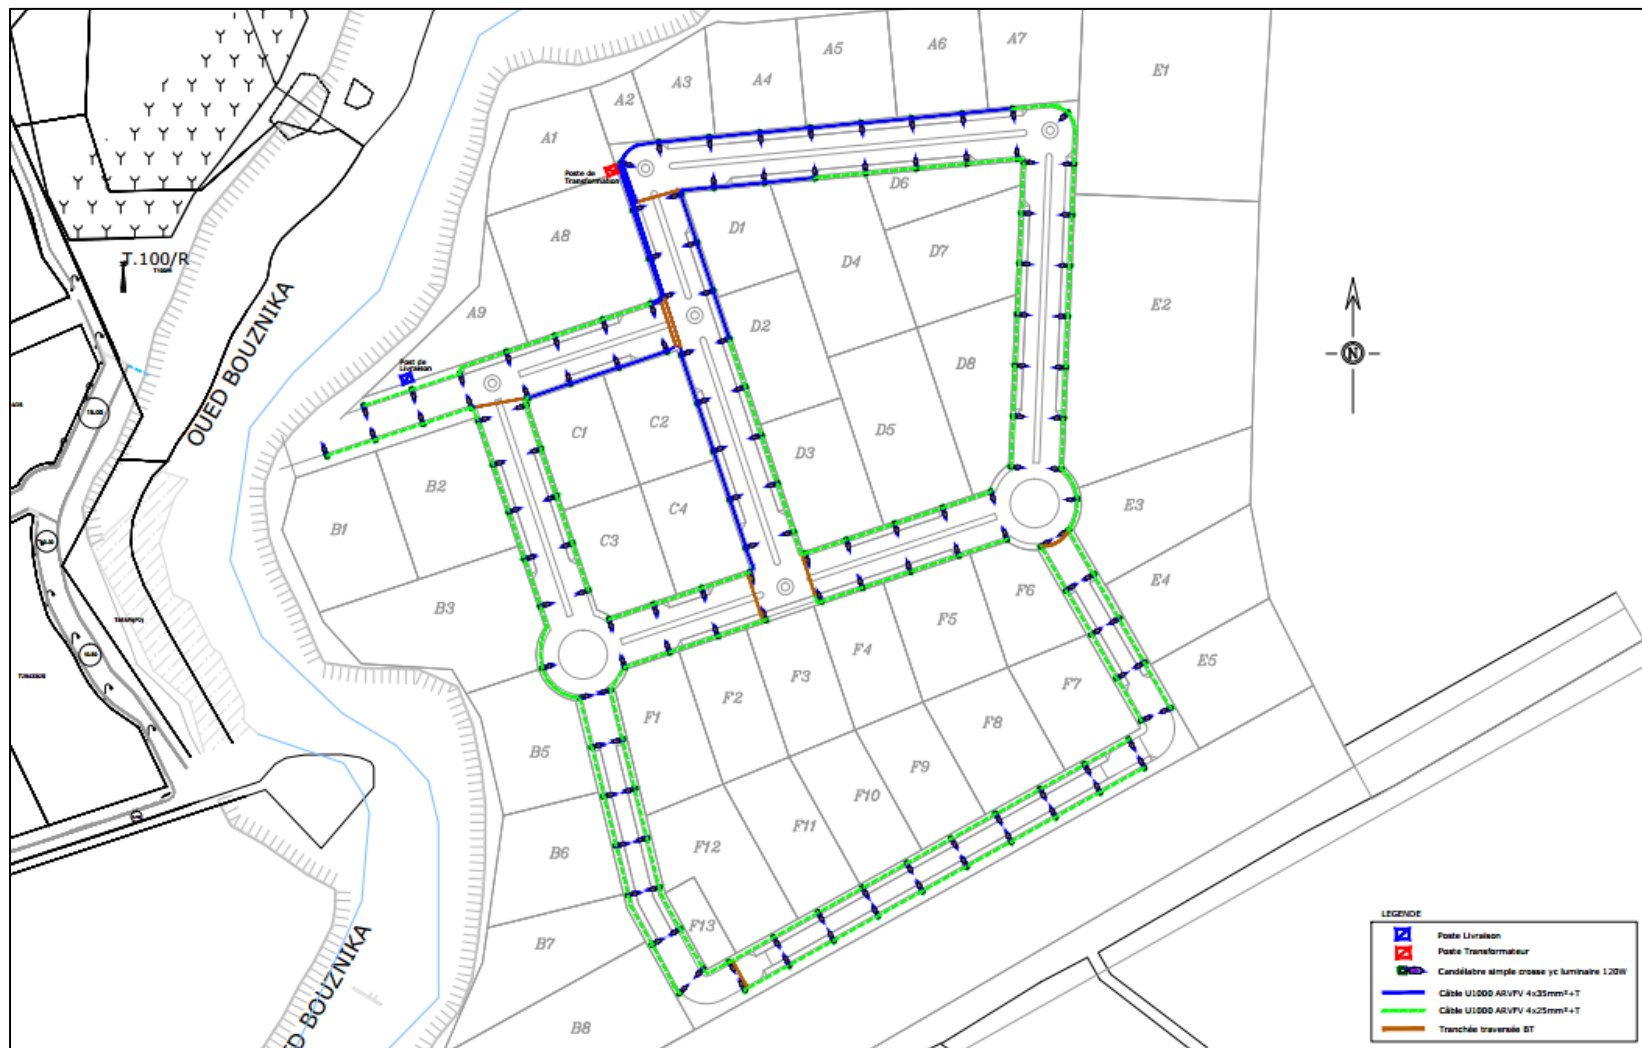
Tracé en plan du réseau d'éclairage public – Extension de la ZI.
